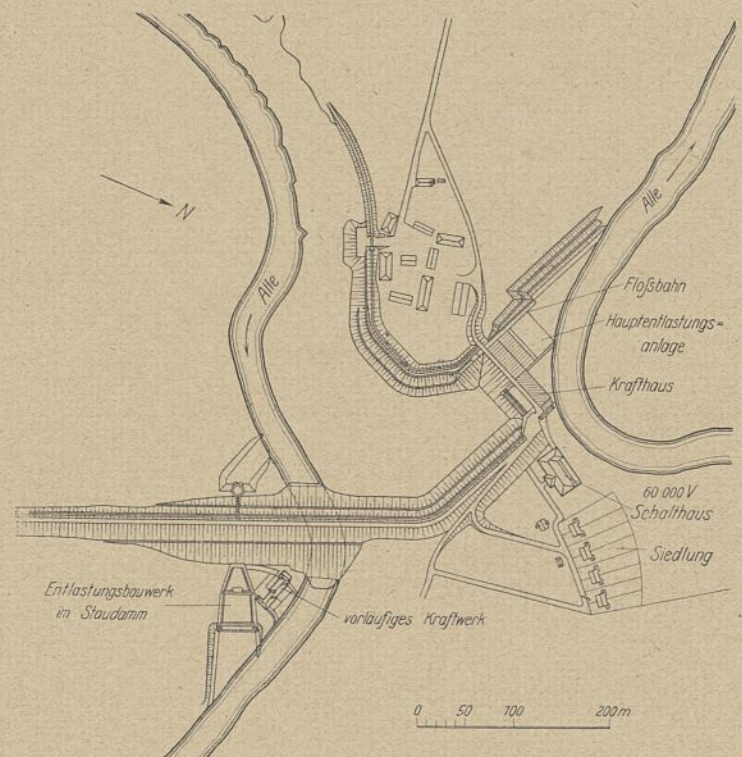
Kraftwerk bei Friedland, Lageplan.
